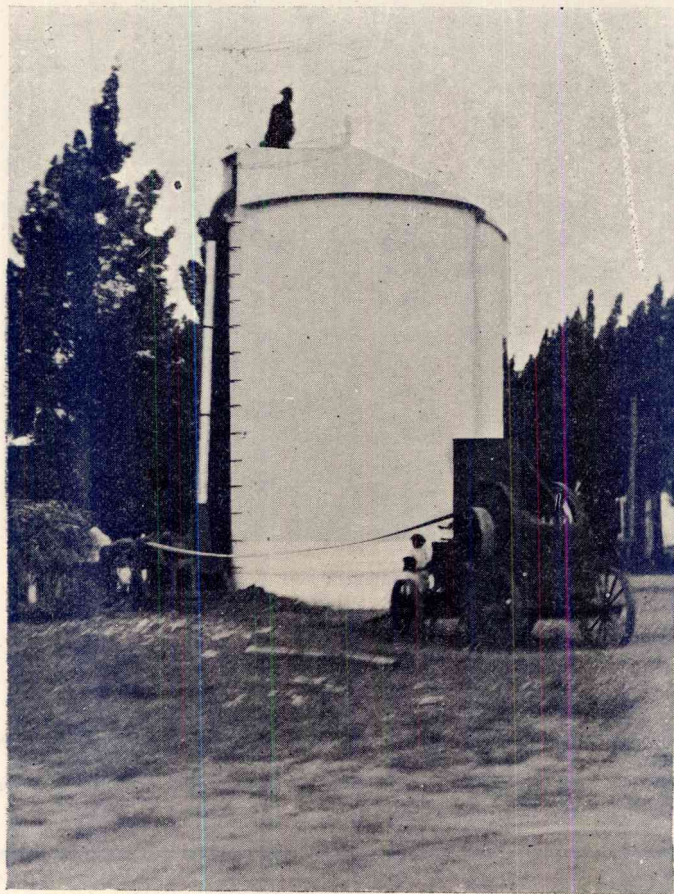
Cargando el silo en cemento armado. Motor y picadora con caño de elevación
